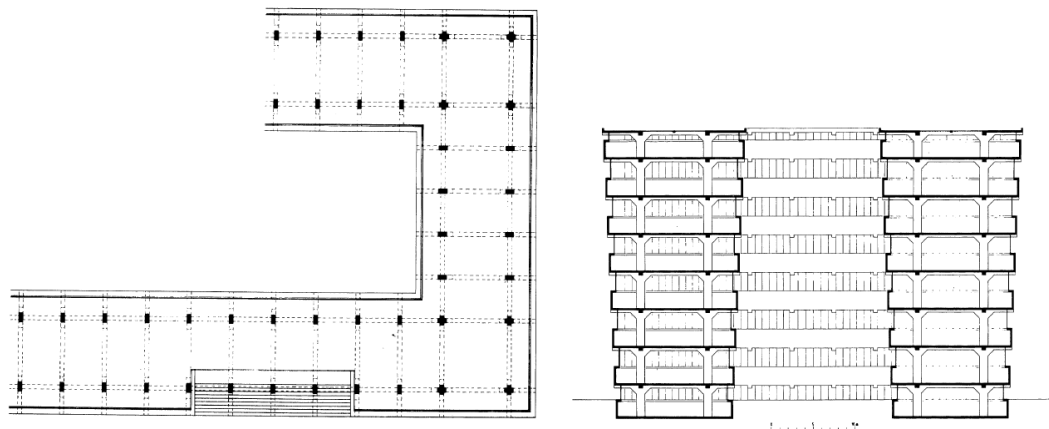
72 ผังพื้น และรูปตัด อาคาร The Reinforce Concrete Office Building
